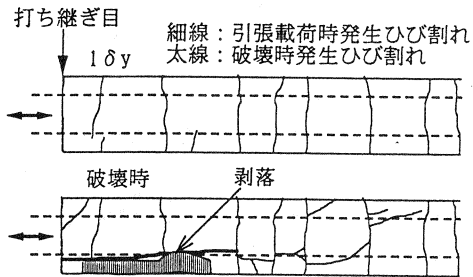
ひび割れ図 (CASE-1 供試体)
